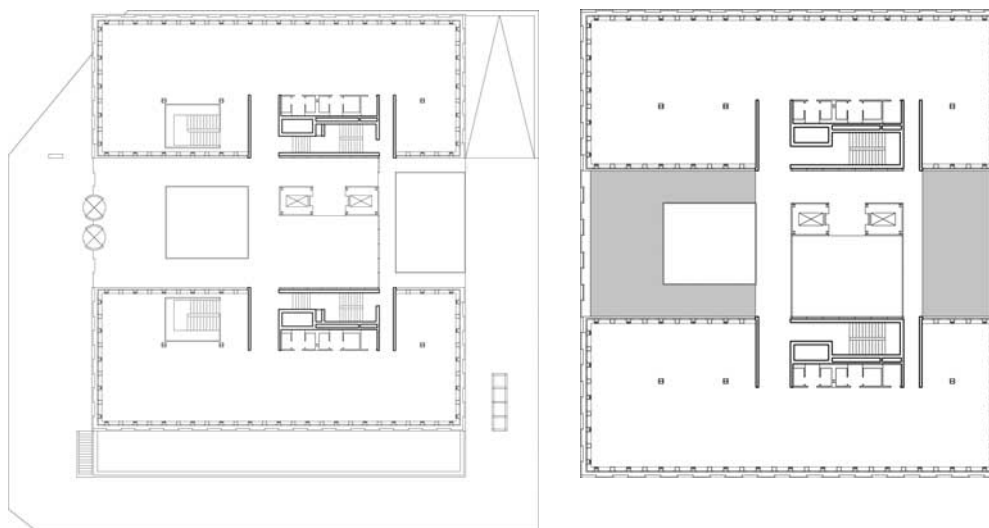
/b: Grundriss EG (links), Grundriss 3. OG (rechts) (© Petzinka Pink Architekten)
